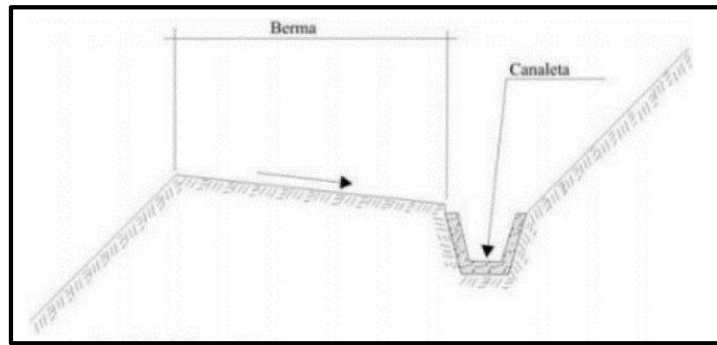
Detalle de una canaleta de drenaje superficial (zanjas de coronación).
